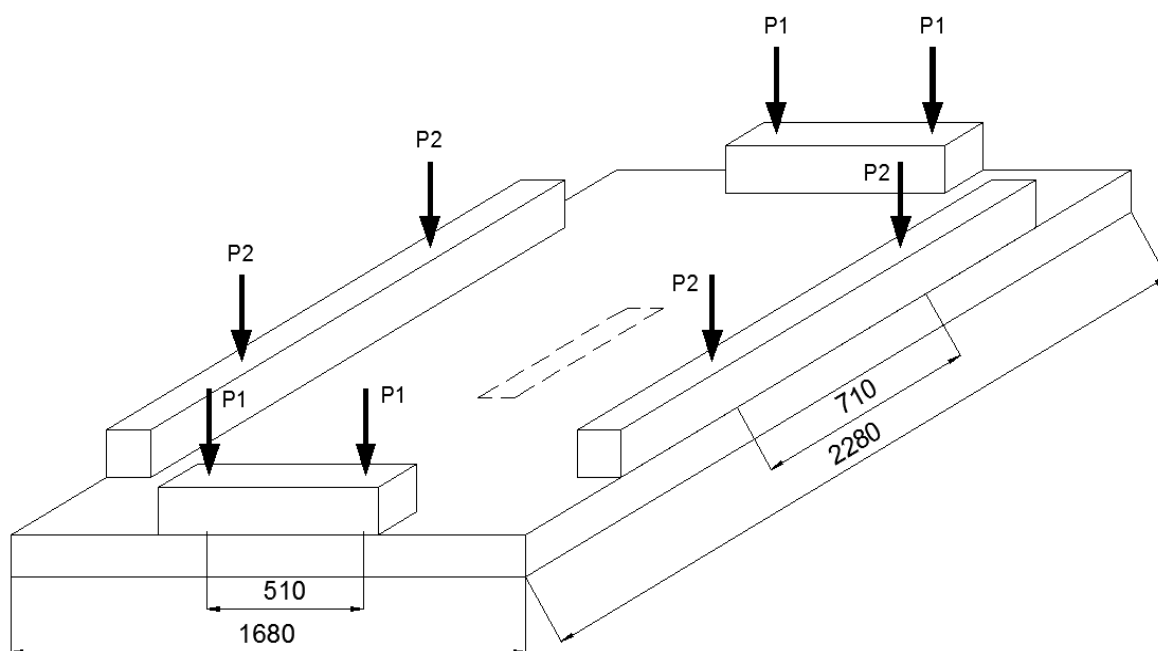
13 - Posição do carregamento nas lajes ensaiadas por Oliveira (2003).
